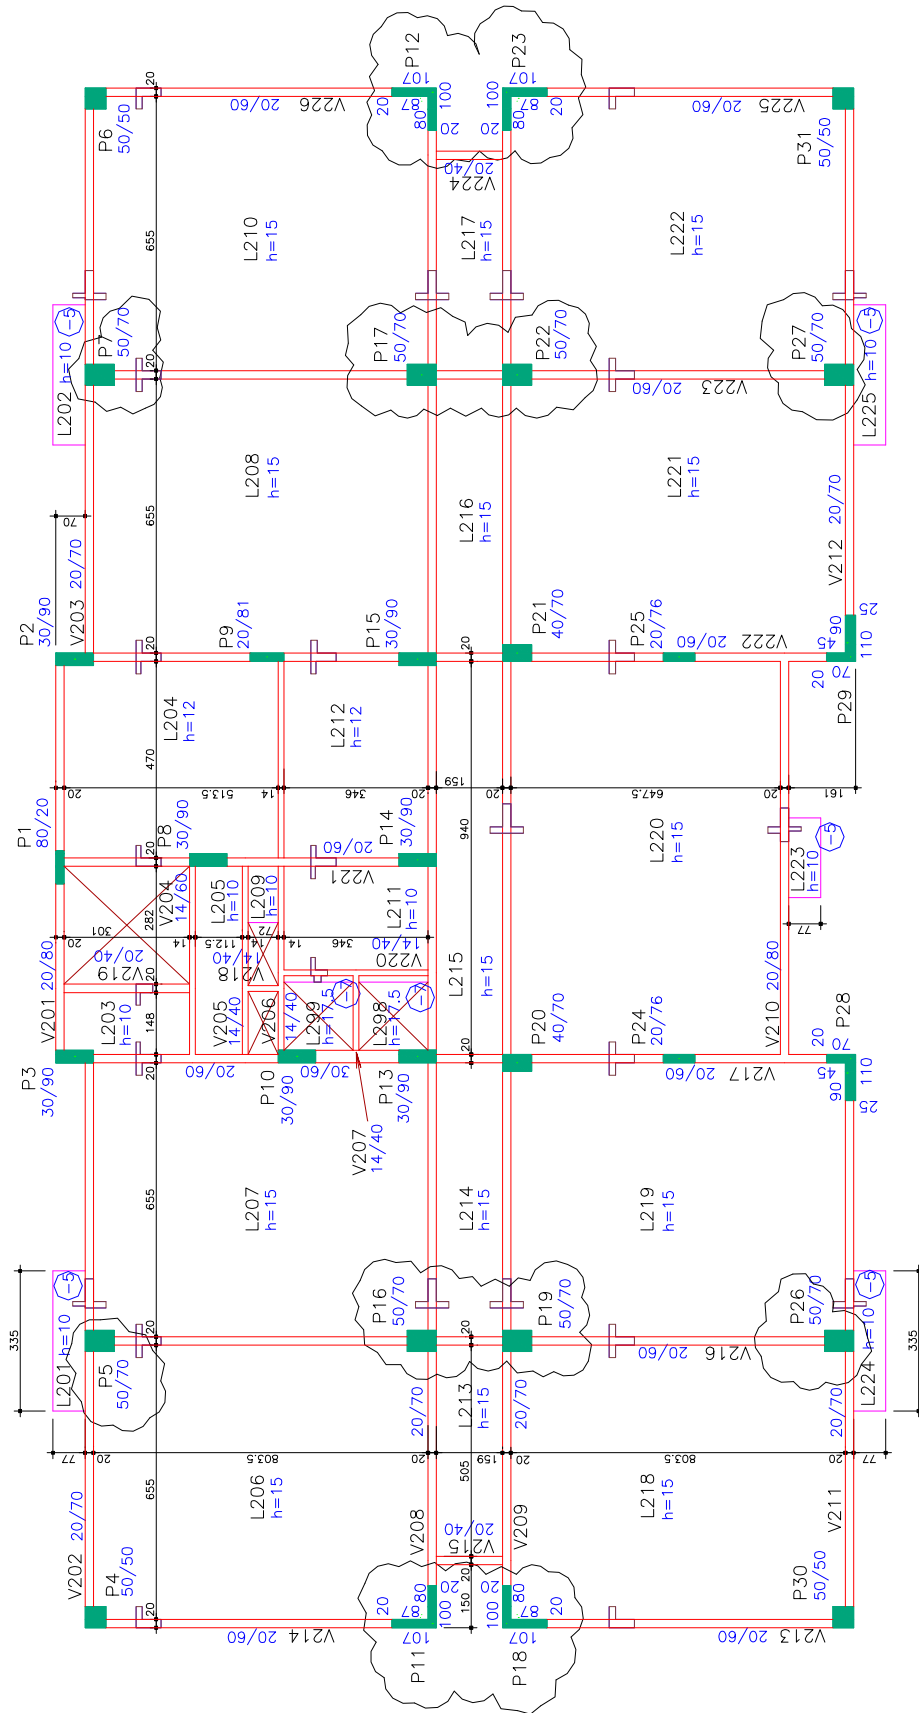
planta de fôrmas do pavimento tipo segundo a NBR 6118/ 2003
